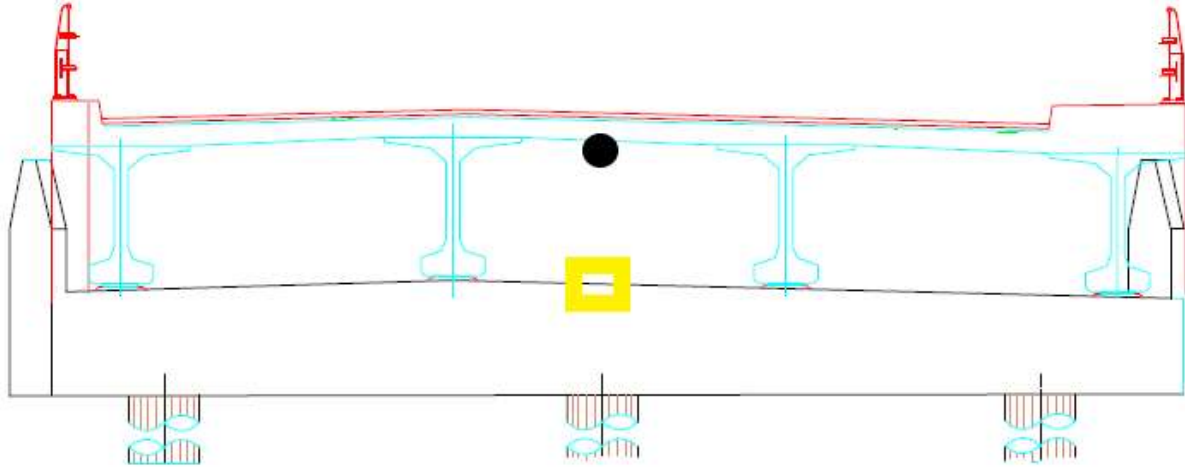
Vista Corte a L/2, instalación de sensores
